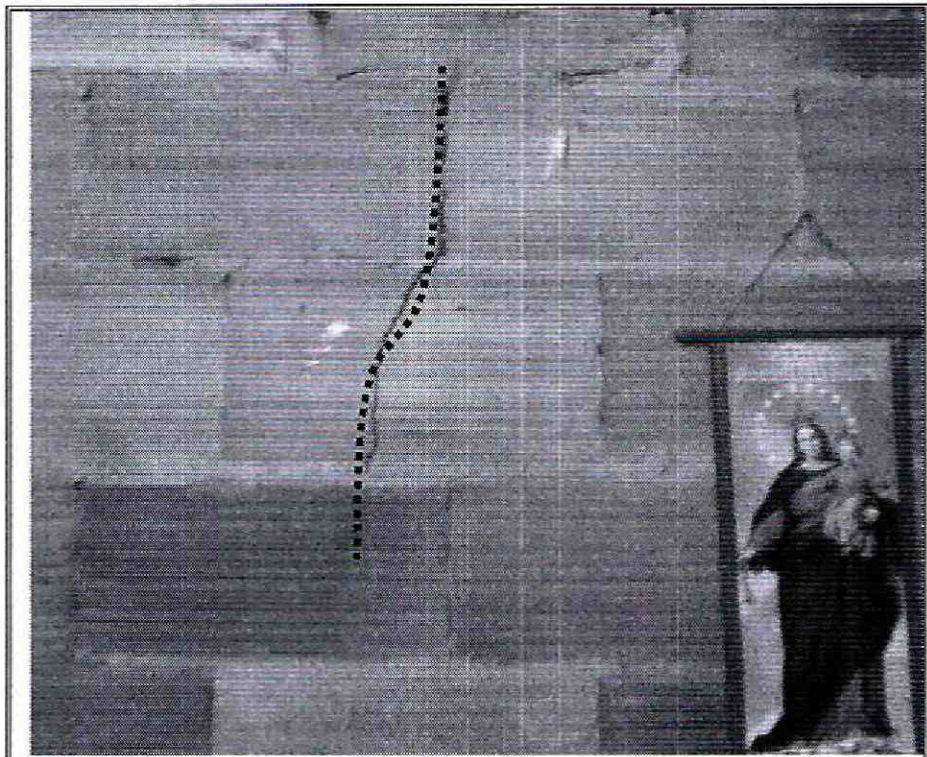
Fisuras de tendencia vertical, en el muro de cerramiento del costado oriental, en la vivienda evaluada.
